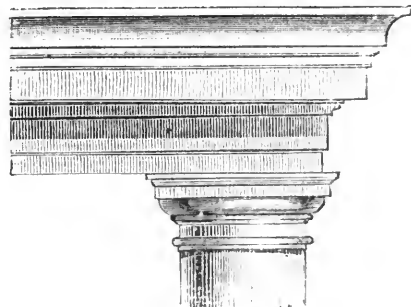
Cornice architravata del portico del palazzo Marino, in Milano.
